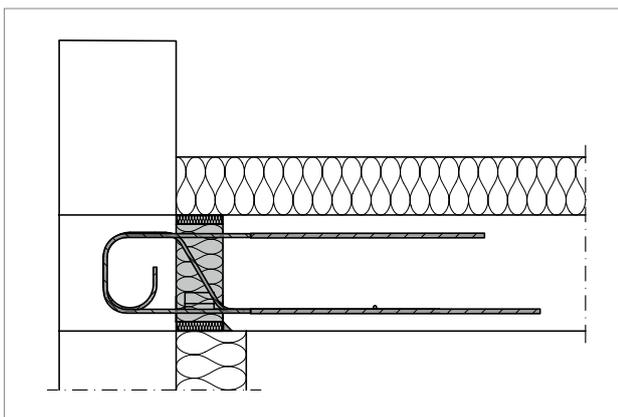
Schöck Rutherma® T type DFi : liaison pour l'acrotère et dalle en béton coulé sur place
